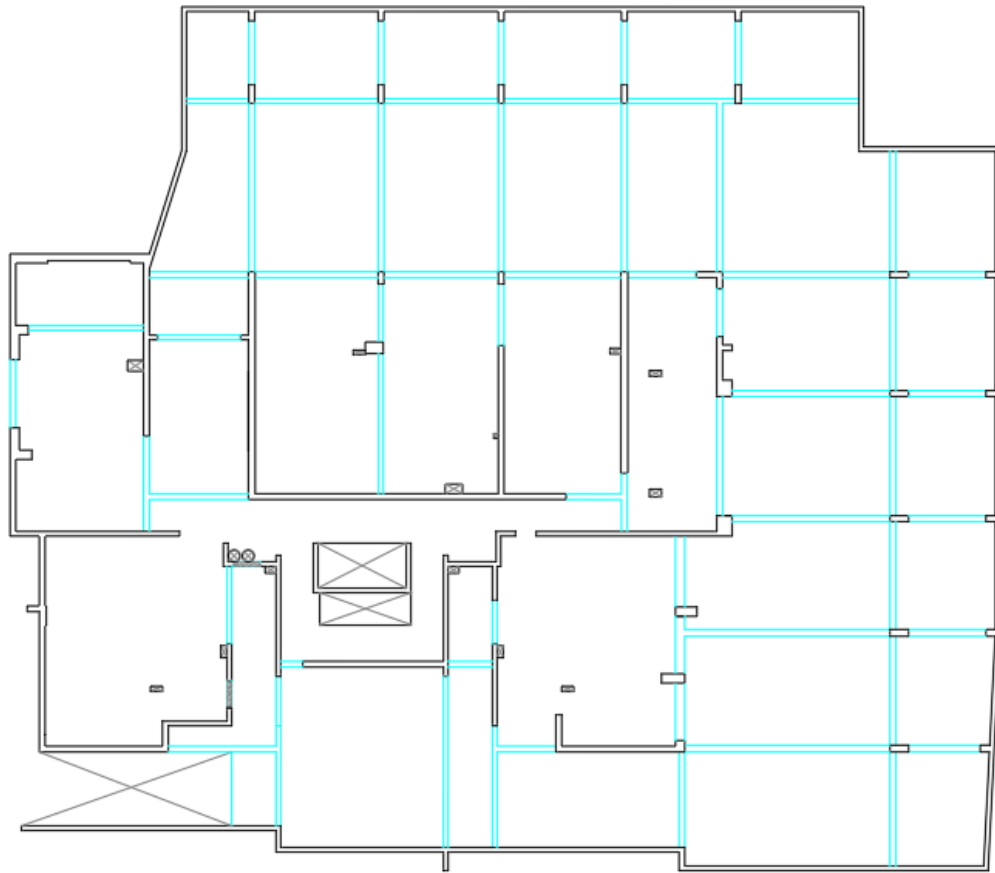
Adaptación de plano estructural de planta del subterráneo -1.
